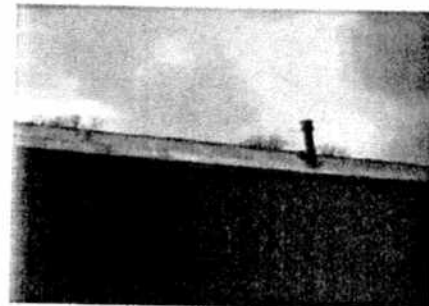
gesaneerd gedeelte dak van schuur achter de woning nr 6
